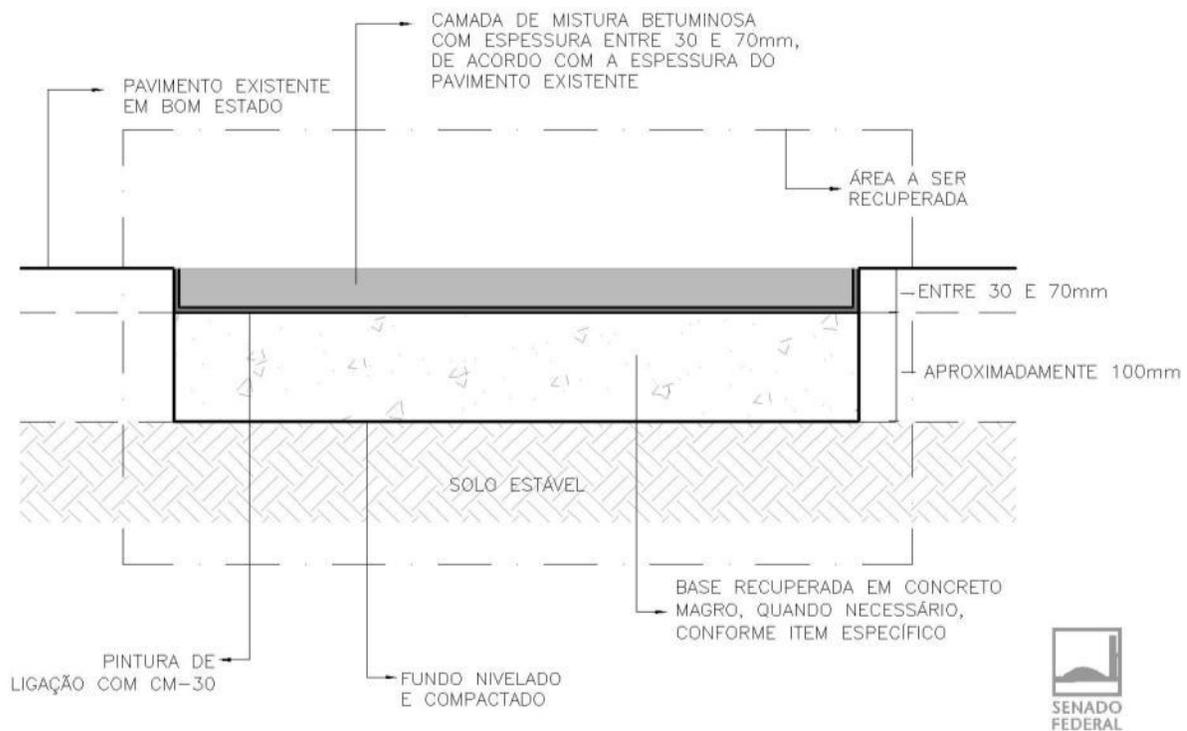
Detalhe esquemático da recomposição de pavimento asfáltico
